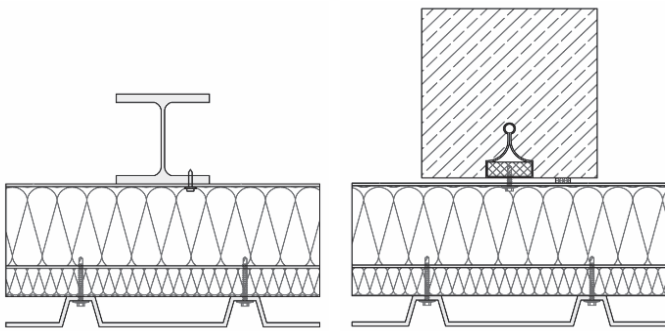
Befestigung von Kassettenwänden an Stahl- bzw. Stahlbetonstützen
